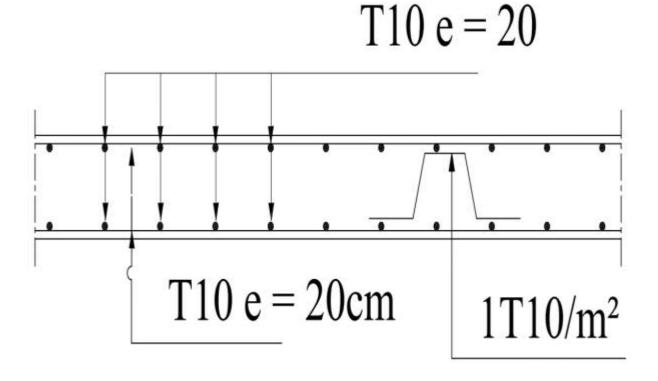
Schéma de ferraillage de la dalle machine d'ascenseur.
